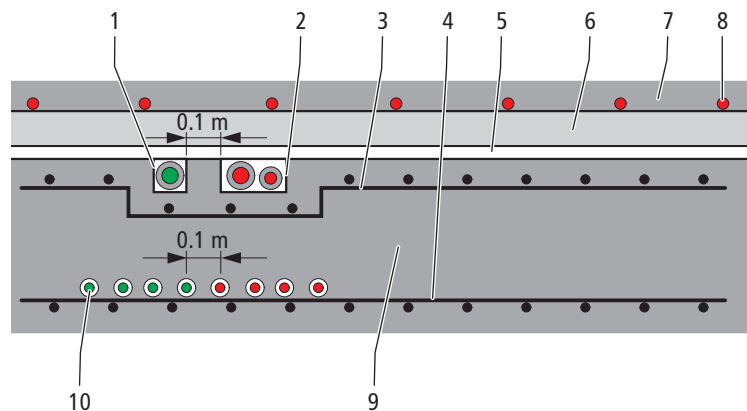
Sezione della struttura del pavimento (in conformità a W3/C3:2020, All. 7, fig. 20).
